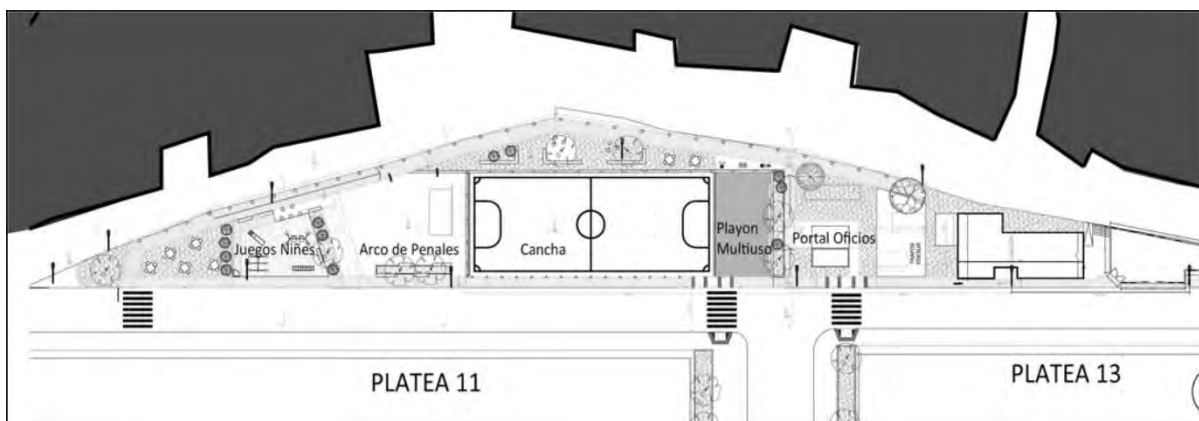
Proyecto de espacio de uso común entre P11 y P13.
